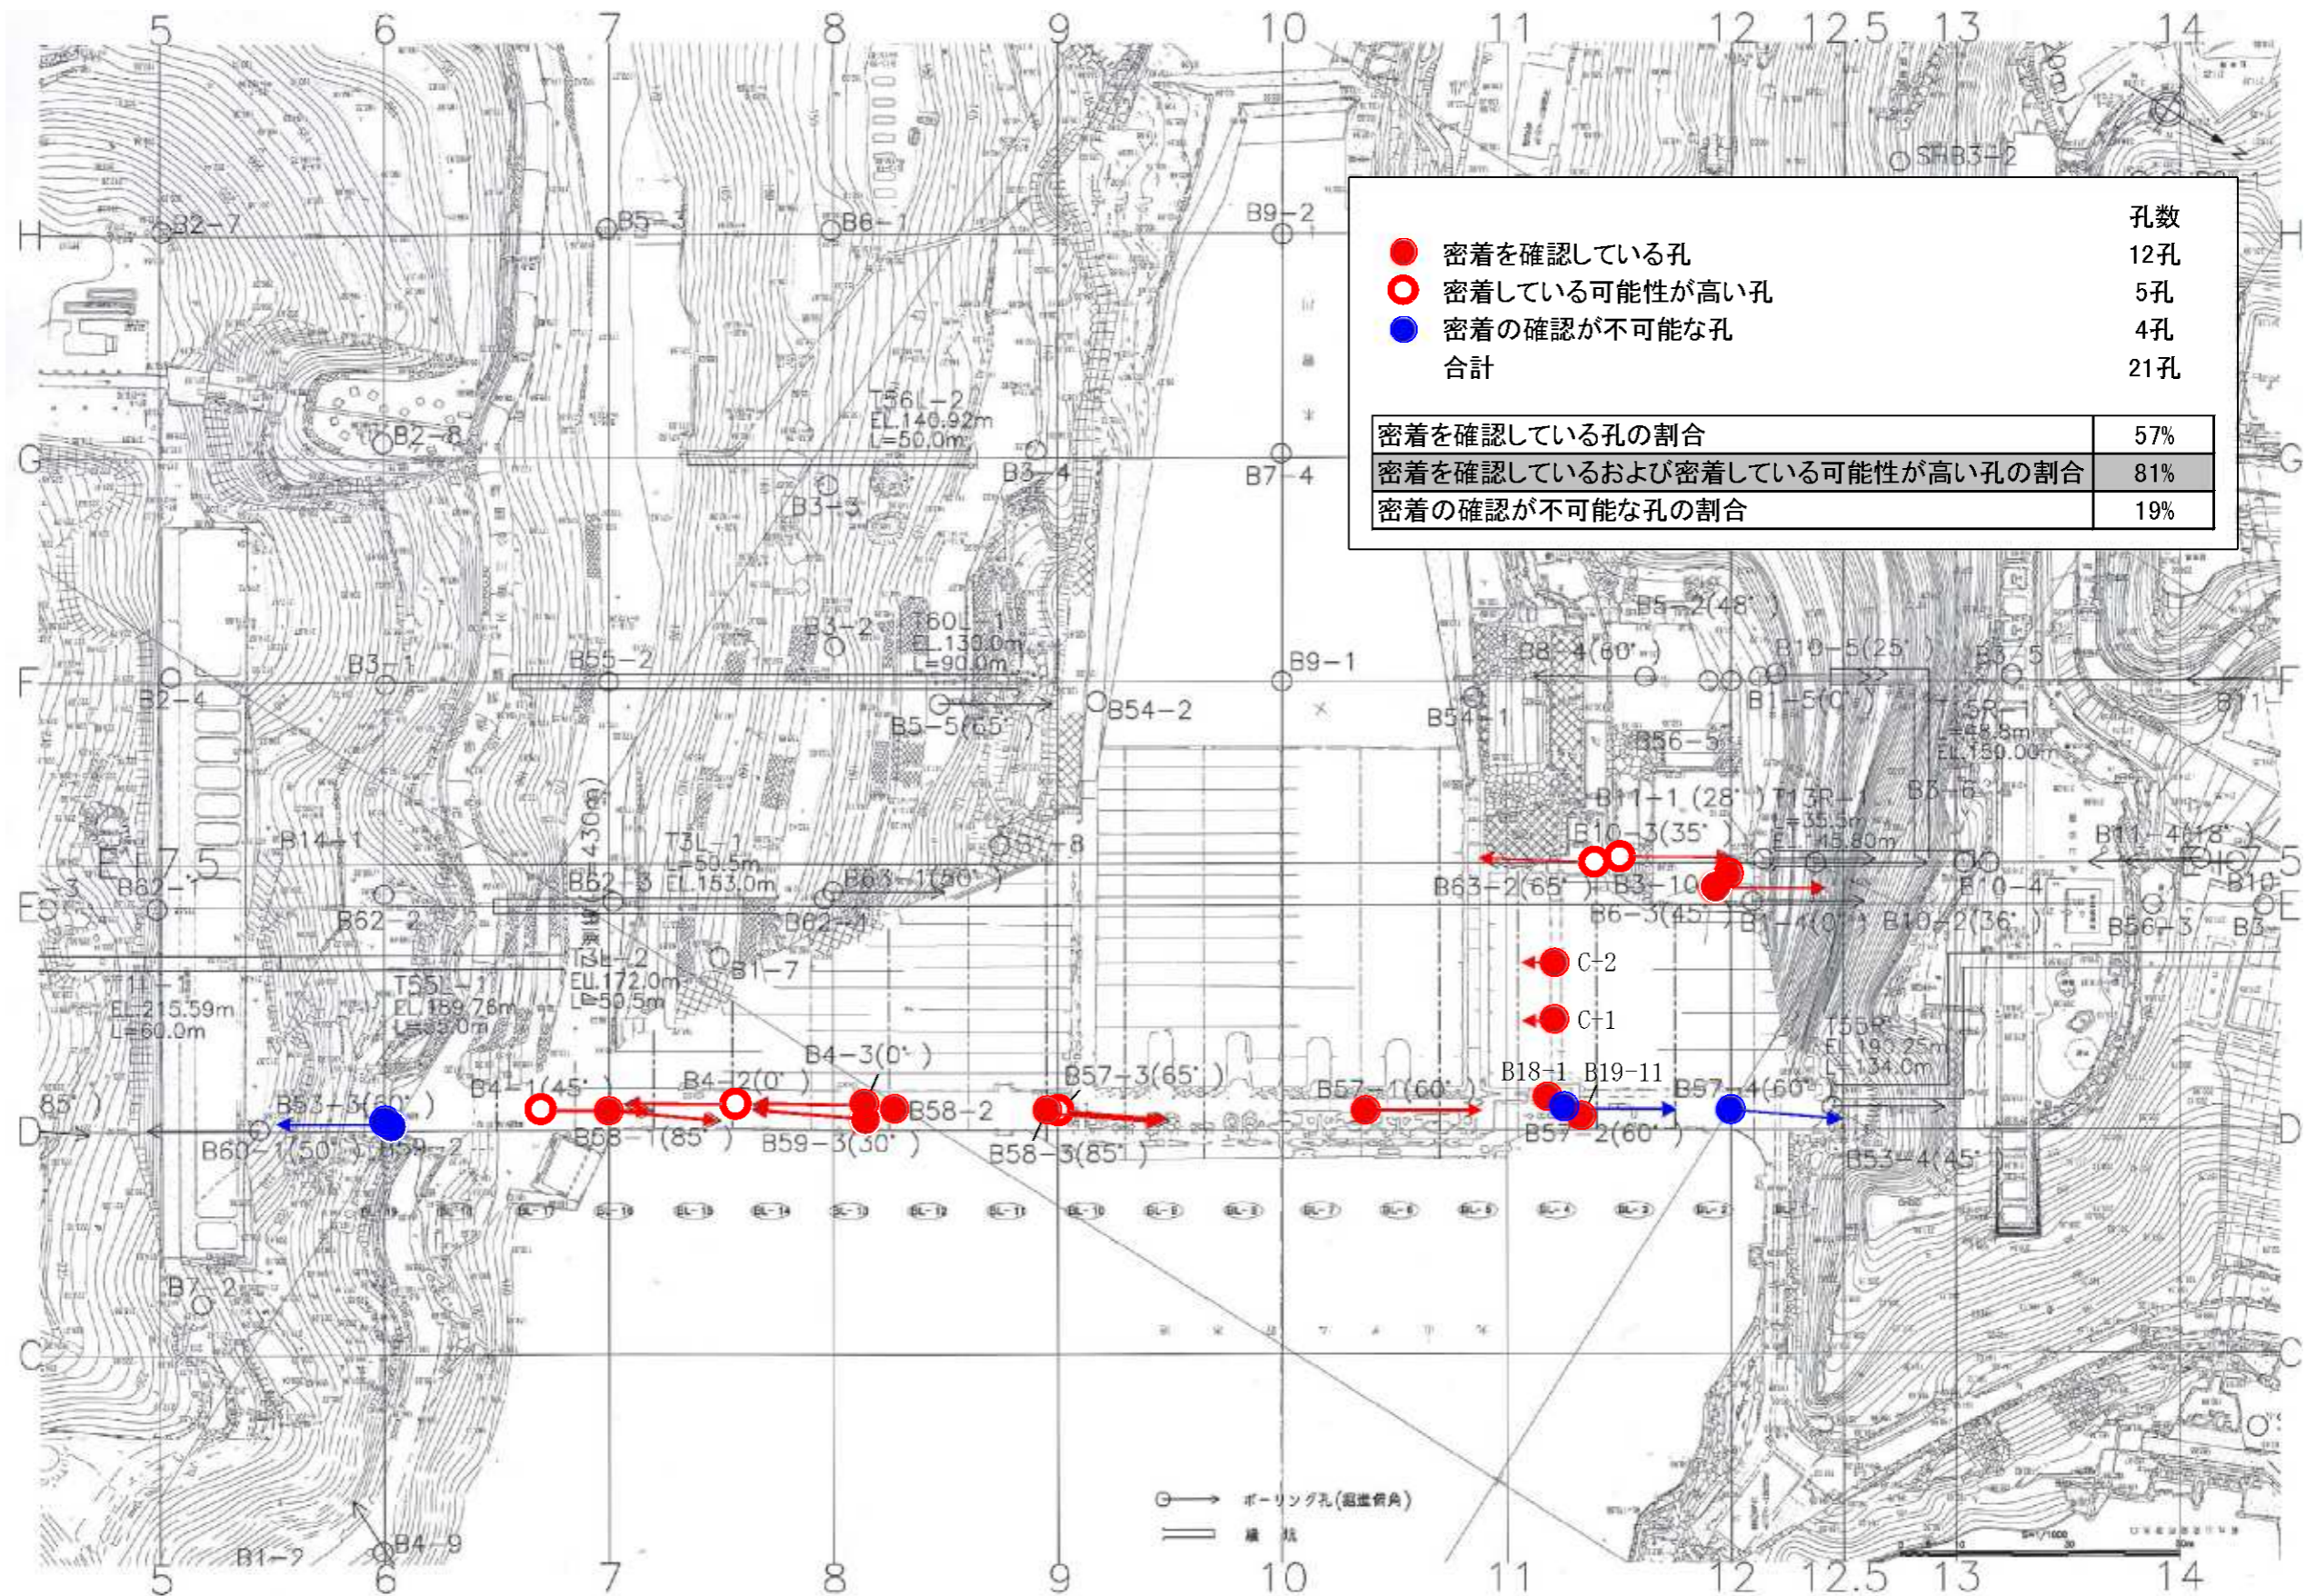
コンクリートと基礎岩盤の密着度平面図
